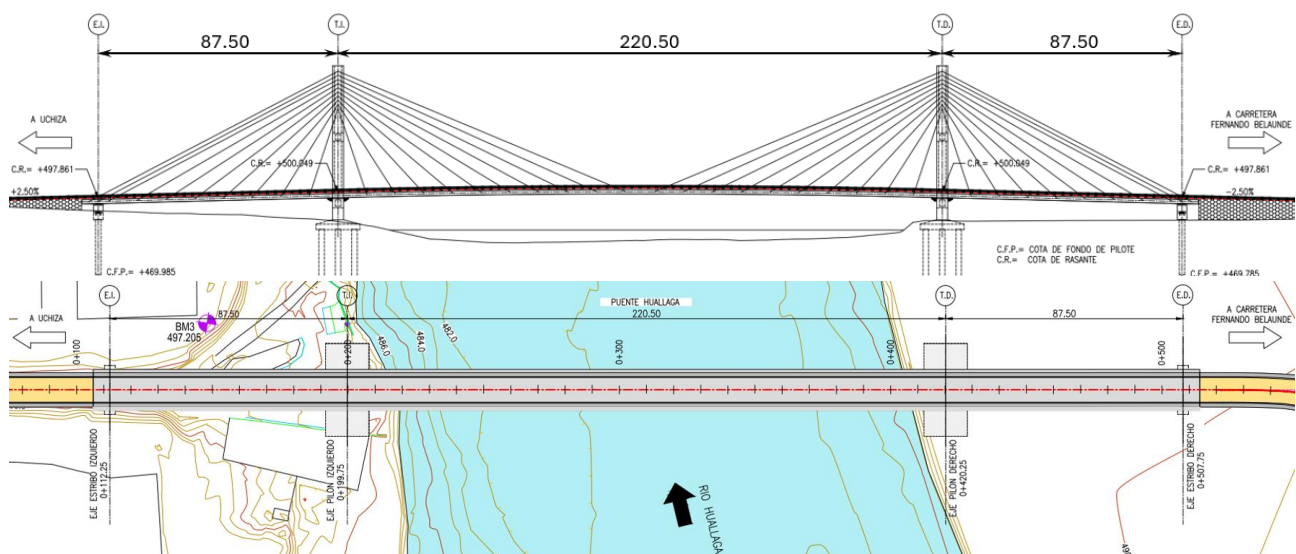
Elevación longitudinal y planta general del Puente Huallaga. Cotas en [m].
